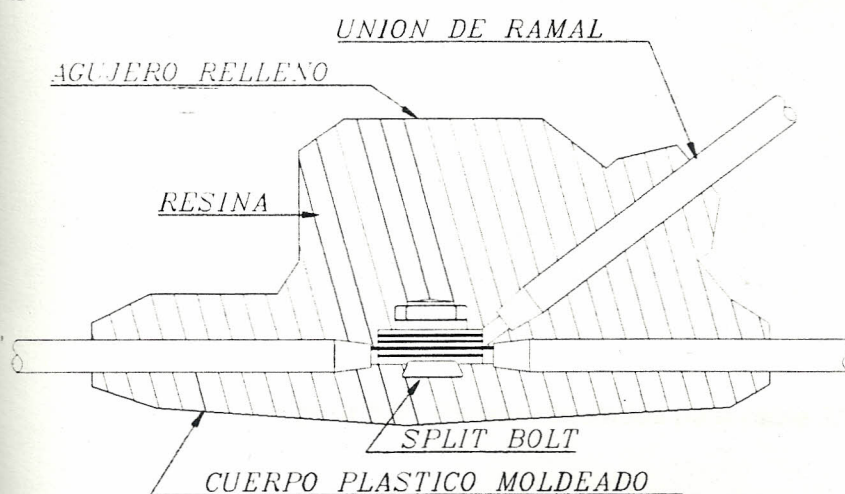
Kits de aislamiento en junta de cables eléctricos
